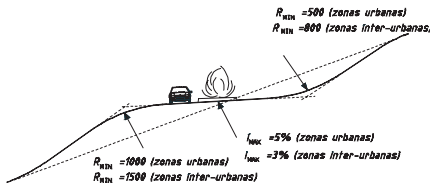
Restabelecimento do perfil longitudinal para implantação da rotunda
